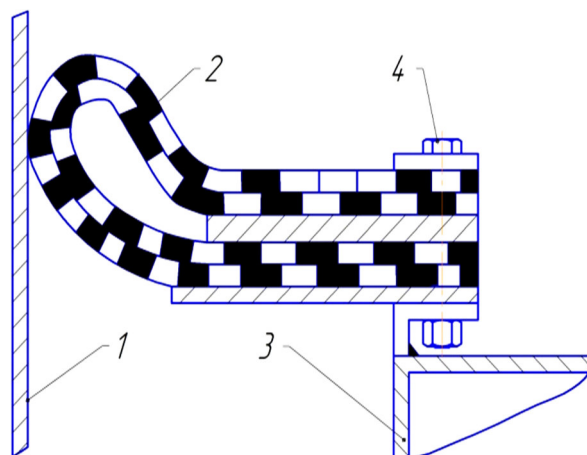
Схема мягкого затвора петлевого типа: 1- стенка резервуара; 2– гибкий уплотнительный элемент; 3– корпус понтона; 4– детали крепления
